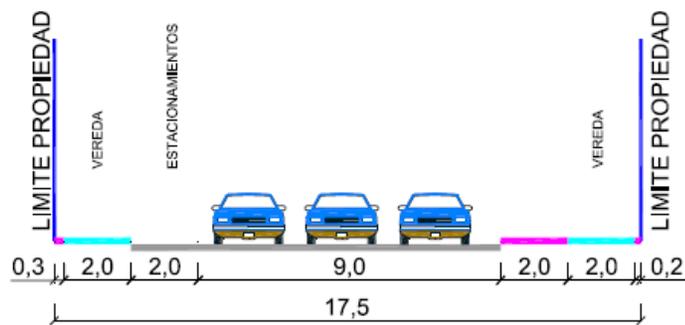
Perfil Tipo Av. San Martín, Santa Teresa - Caupolicán
